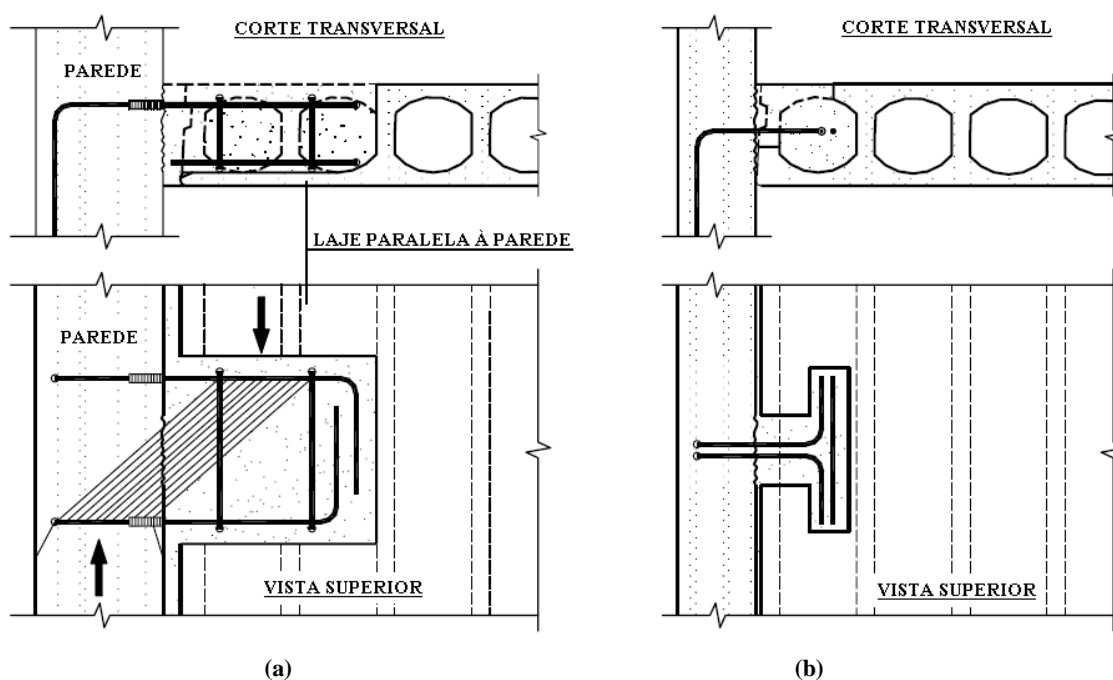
Conexões das lajes alveolares junto às paredes de cisalhamento (laje paralela à parede): (a) Junção laje/parede como um “consolo”; (b) Junção por ancoragem da armadura (BASEADO EM: FIB, 2008).
